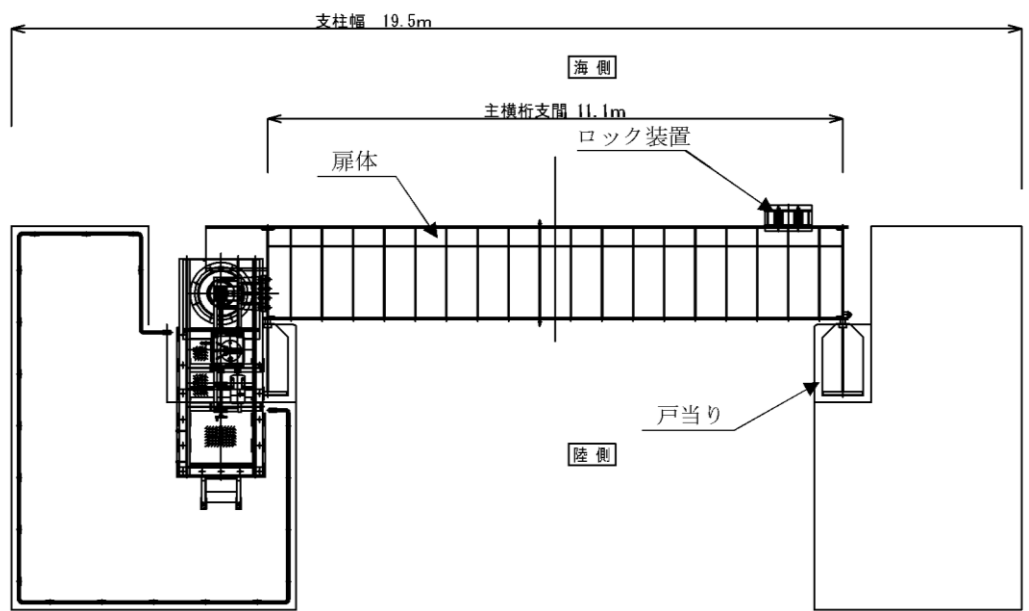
(2) 漂流物対策工の構造図 (鋼製扉体, 平面図)
